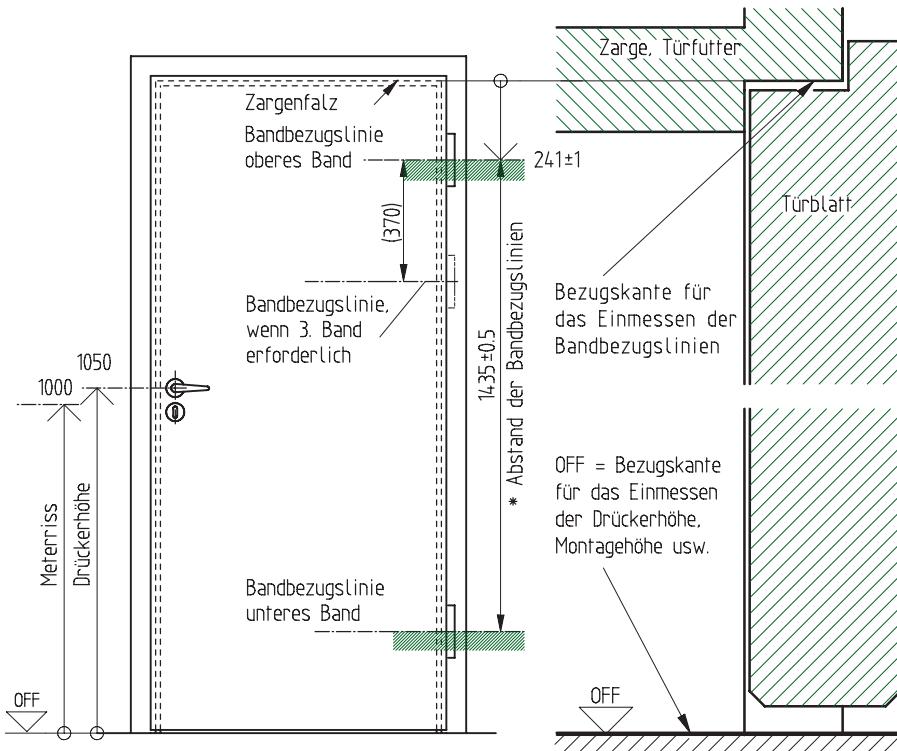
Bandbezugslinien und Drückerhöhe bei Zimmertüren (gem. DIN 18268 u. 18101).
